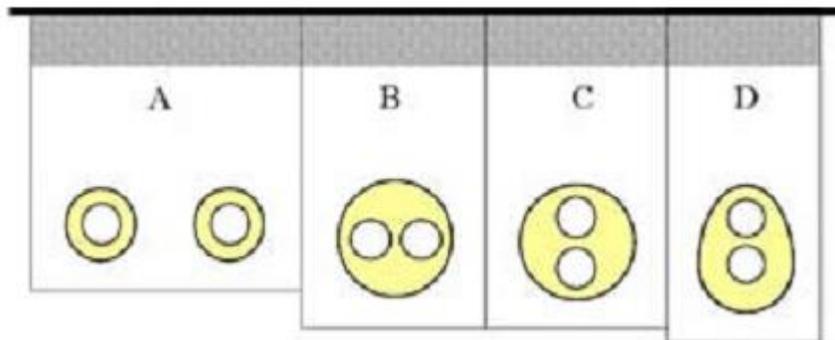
Tipos de tuberías para sistemas de calefacción distrital: a) Par de tuberías simples. b) Tuberías gemelas horizontales. c) Tuberías gemelas verticales. d) Tuberías gemelas con forma de huevo.
